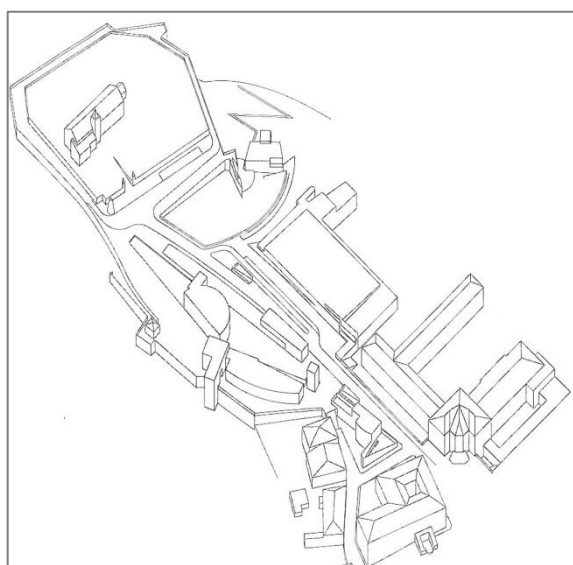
Representação aérea do Plano de Pormenor da Vila Velha (1988)
